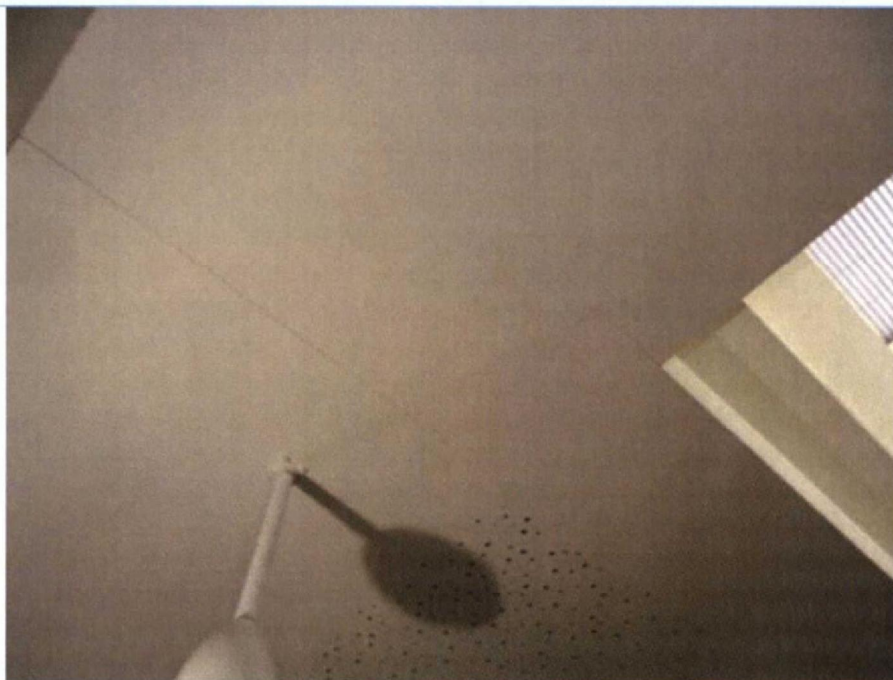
Scheuren bij overgang plafond-wand. Geen verband met bodemtrillingen.
